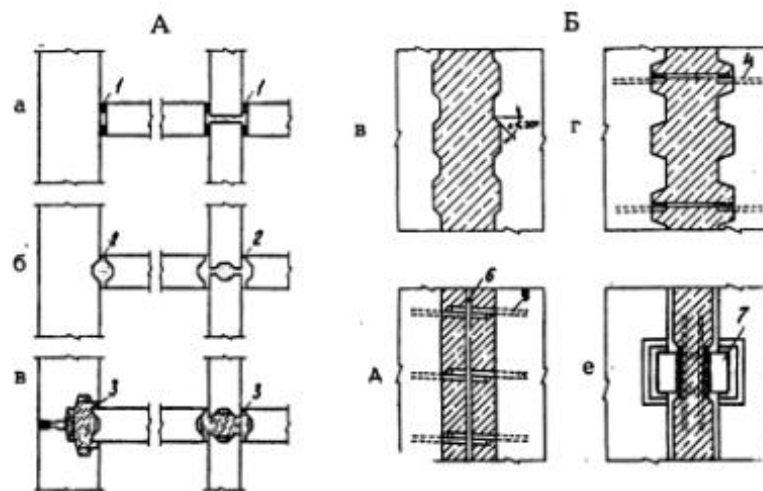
Вертикальные стыки панелей стен: А-в плане; Б-в фасаде; а - плоские; б - профилированные бесшпоночные; в - профилированные с бетонными шпонками; г - шпоночный с замоноличенными стальными связями; д - с вертикальным армированием по горизонтальным петлевым выпускам; е - со стальными замоноличенными шпонками; 1 - звукоизоляционная прокладка; 2 - раствор; 3 - бетон замоноличивания; 4 - сварная арматурная связь; 5 - петлевой выпуск; 6 - вертикальная арматура; 7 - стальные накладки, приваренные к закладным деталям
